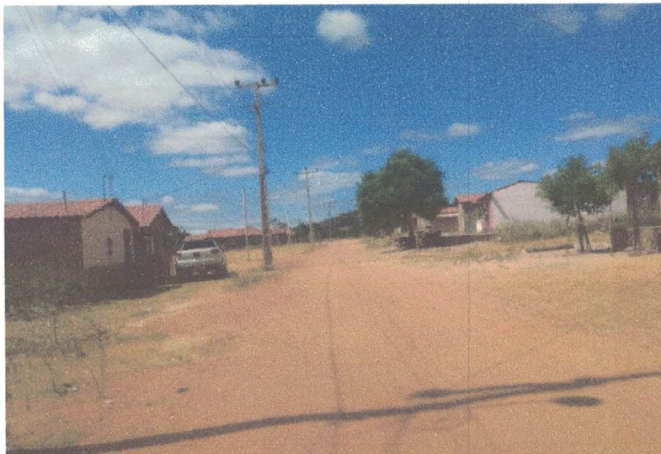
RUA PROJETADA - TRECHO 2
